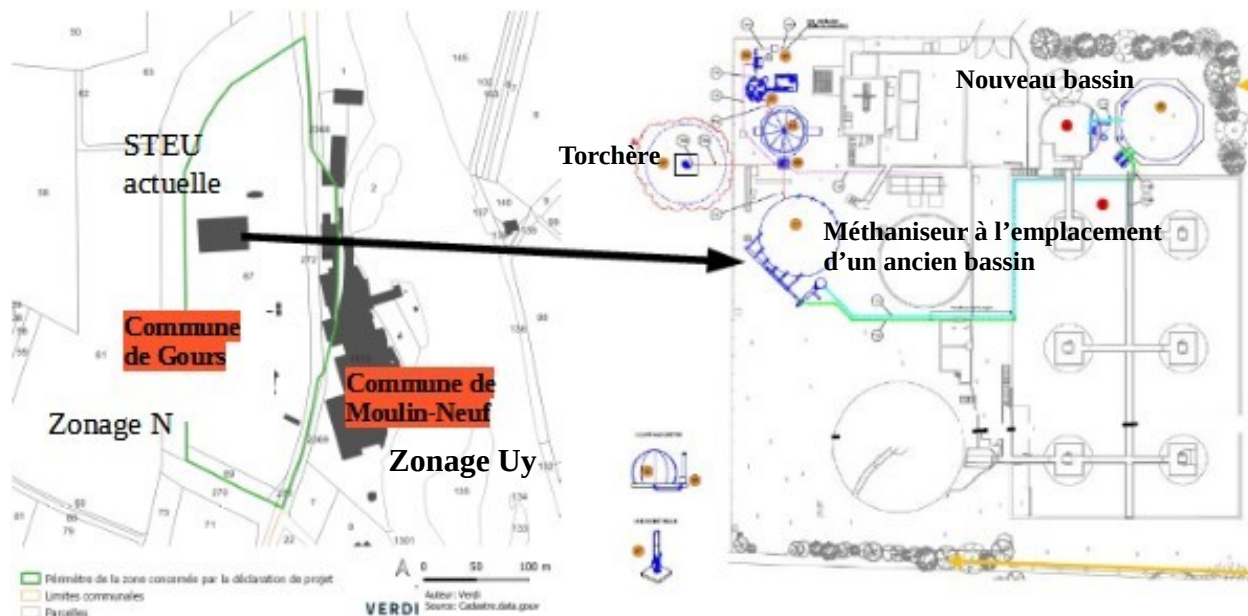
Extrait du plan cadastral et plan de masse du projet retenu (Source : notice explicative, pages 25 et 176)
